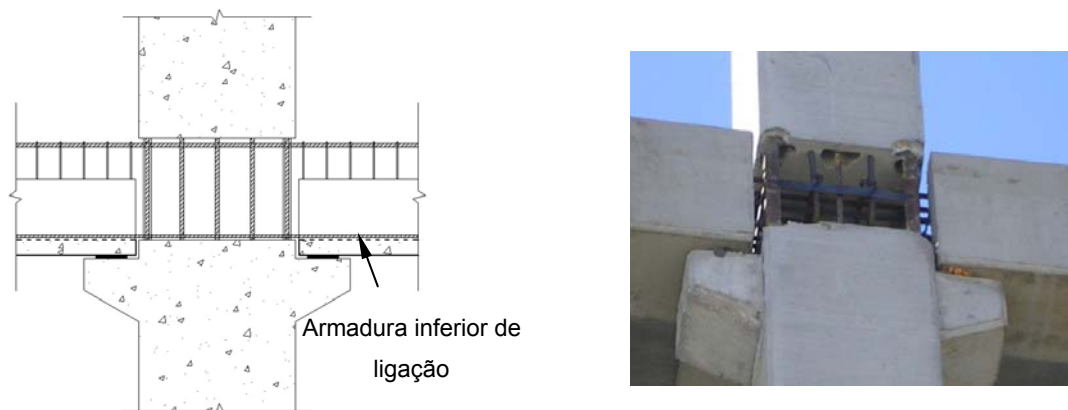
Ligação viga – pilar com continuidade de armaduras⁴
